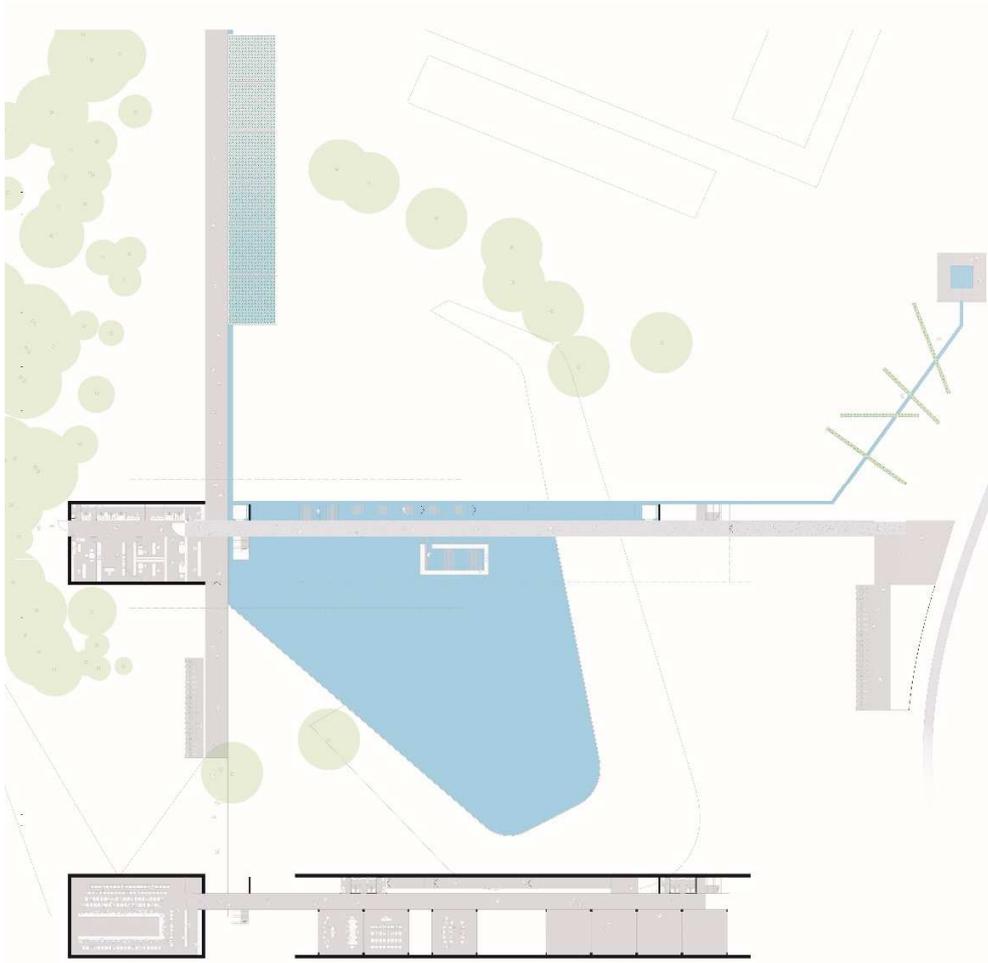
Planta baixa (subsolo e térreo) – CS 49
